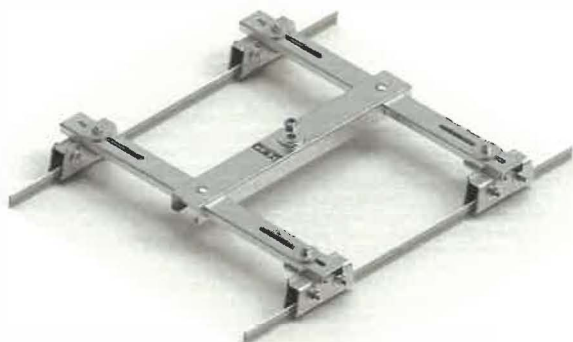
Anschlageinrichtung Typ A, Typ: FALZ-45
